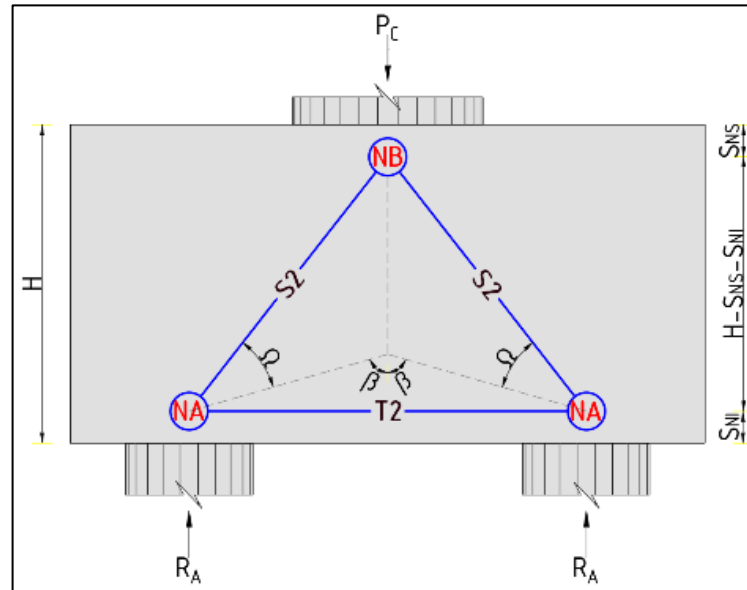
DADO DE PILOTES-ALZADO LONGITUDINAL DEL RETICULADO-MPT
